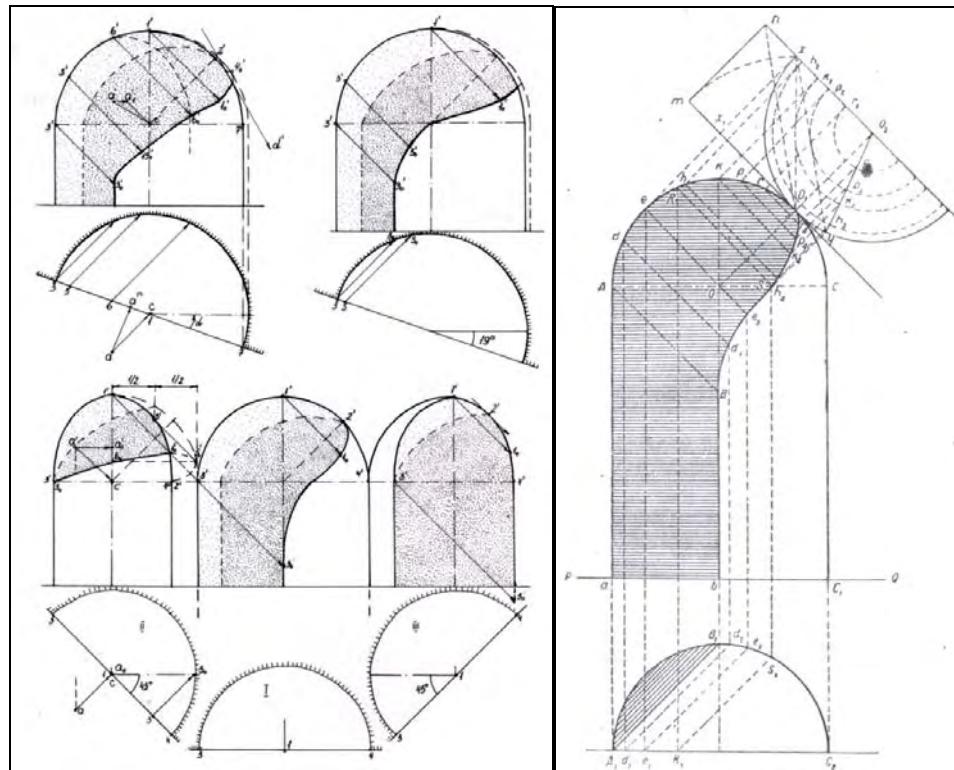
Определение падающей тени в полуцилиндрических нишах со сферическими перекрытиями при любом повороте в плане
